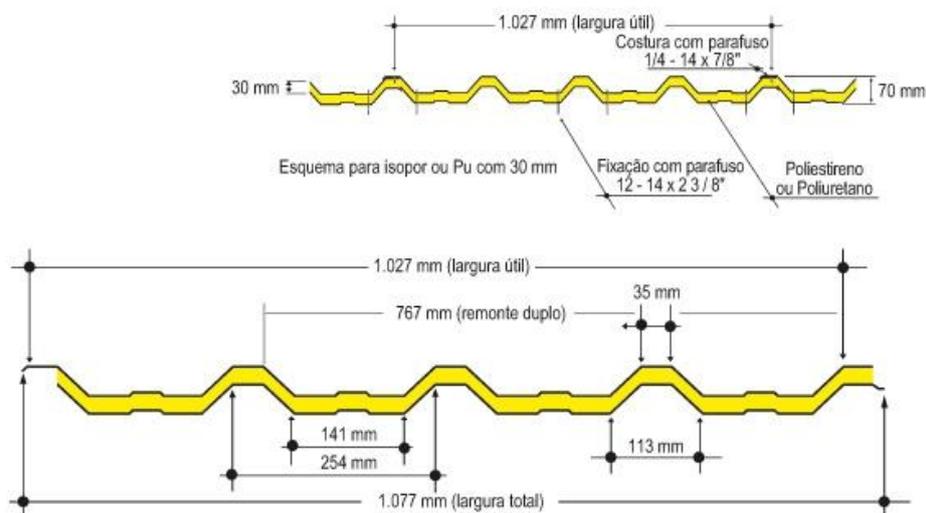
Detalhamento da telha termoacústica trapezoidal
